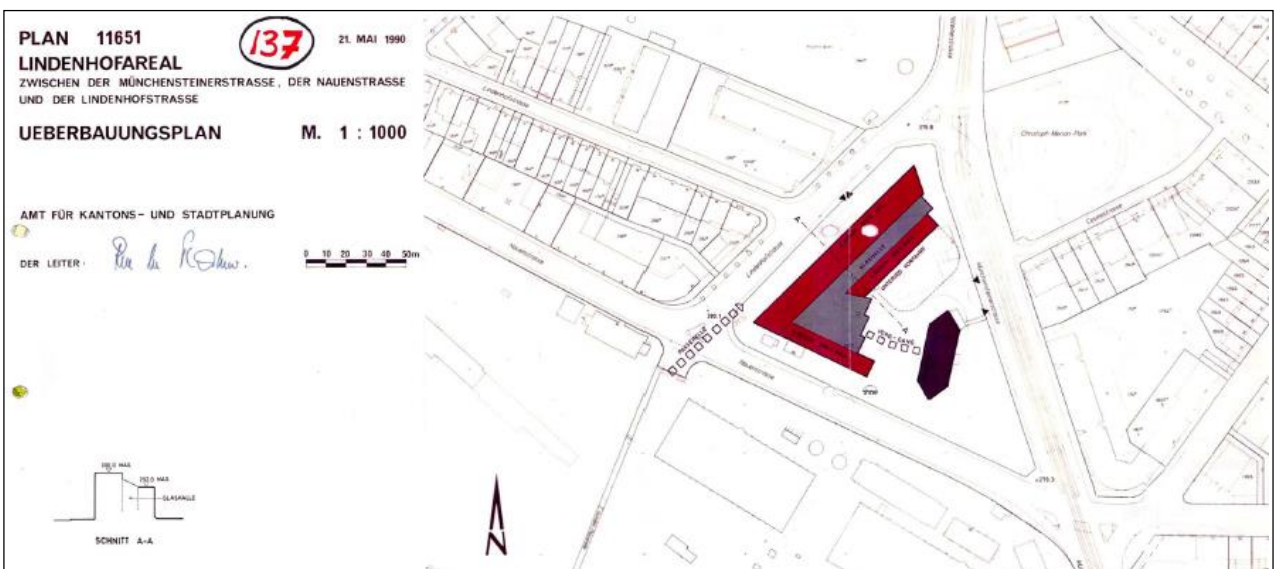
Bebauungsplan Nr. 137 vom 11. Dezember 1991 (kein Massstab, Plan genordet)
